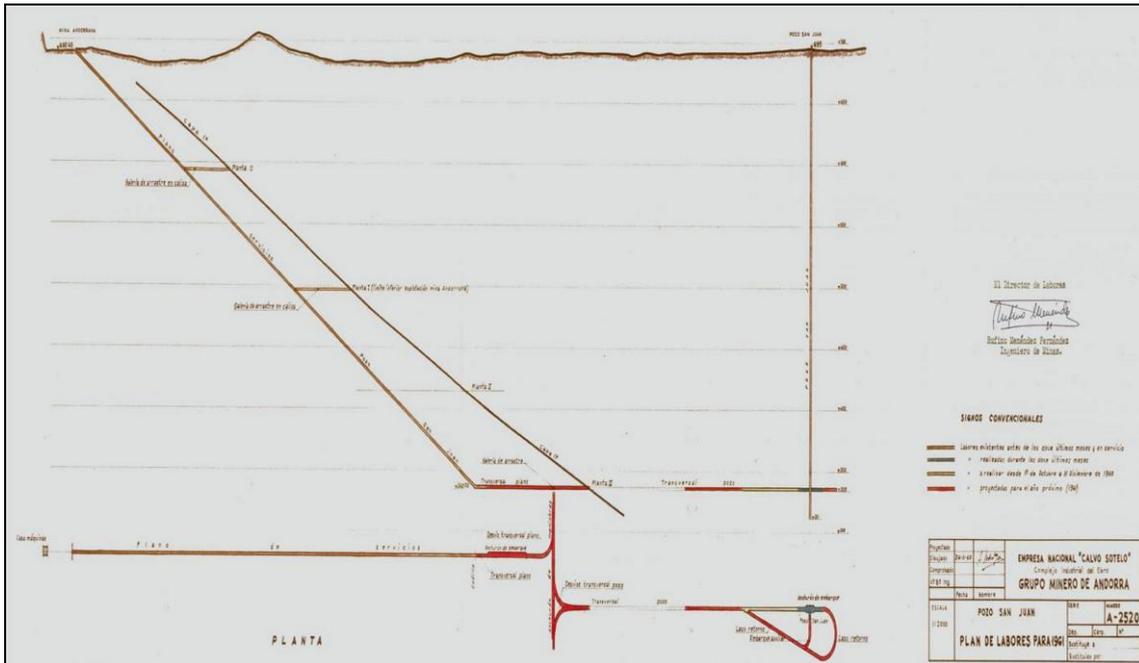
Plano integrado en el Plan de Labores de 1961. Labores planificadas y construidas. Se incluye la comunicación entre Mina Andorrana y pozo San Juan. (Fot. Archivo Celan).
